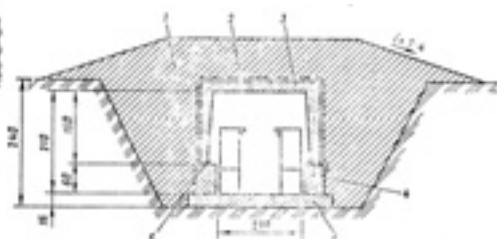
Быстровозводимое убежище из лотковых элементов пешеходных тоннелей: 1 – насыпной грунт; 2 – гидроизоляция; 3 – лотковый элемент; 4 – бетонный блок; 5 – железобетонная плита; 6 – швеллер
